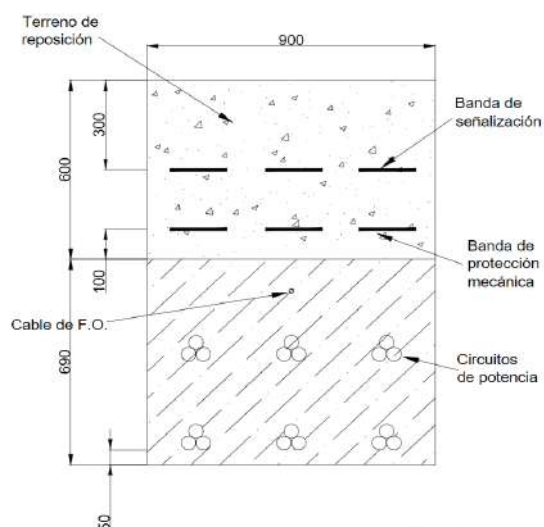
Sección de la zanja tipo. Fuente: OSPREL.
